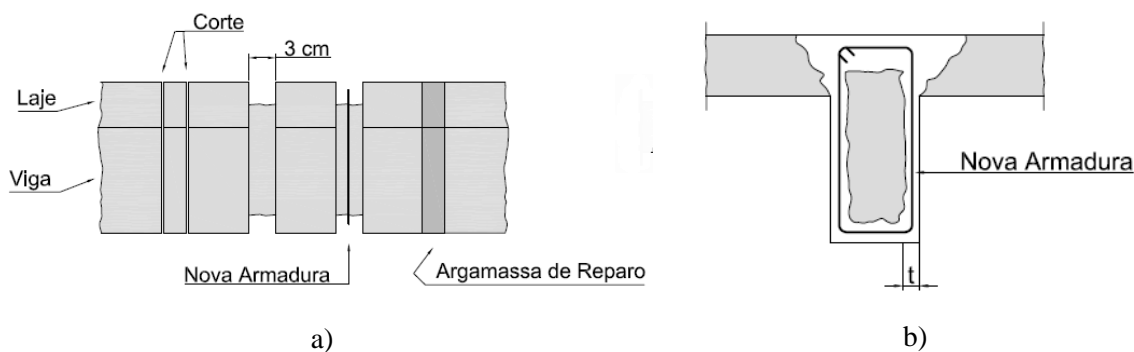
Reforço de vigas ao corte, adaptado de [19].
